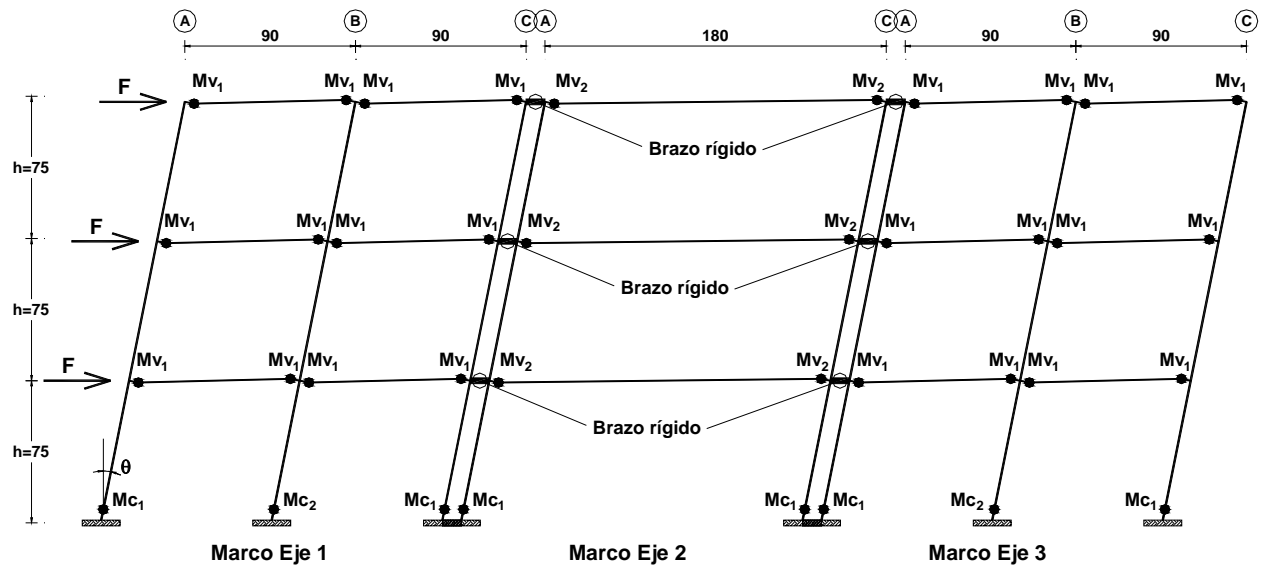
Mecanismo de colapso columna fuerte-viga débil y momentos de fluencia en las articulaciones plásticas de vigas y columnas del espécimen para las fuerzas F aplicadas
